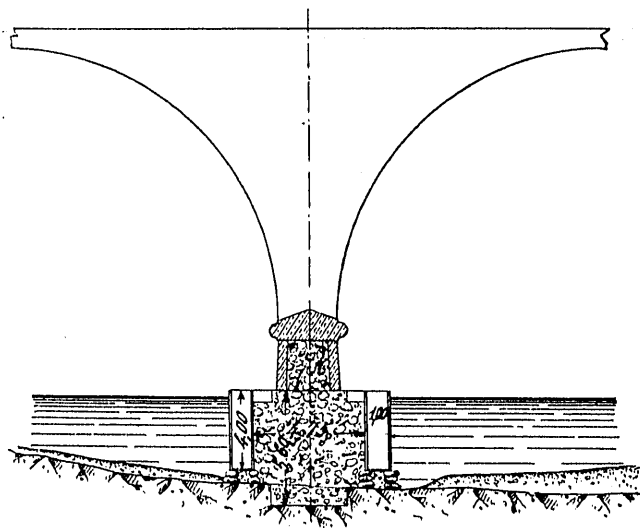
ª Situación del eajón y corte transversal de la pila.
